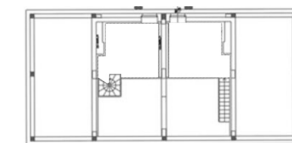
Pianta piano secondo; Fonte: M. Cerula, et. al., 2011;
